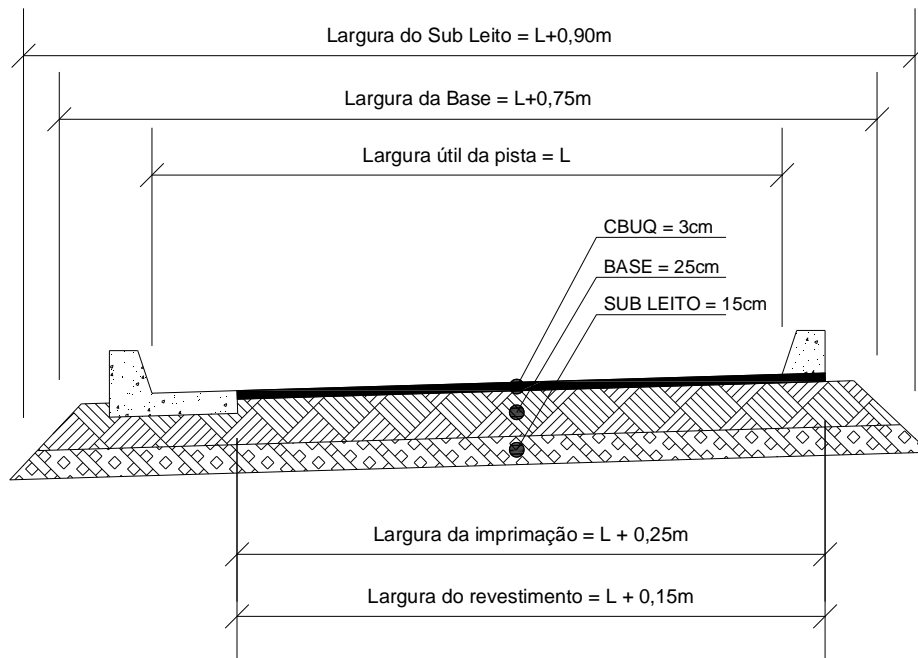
Larguras das camadas do pavimento, das pistas coletoras e arteriais, para caimento simples (chapa para esquerda ou para direita)
